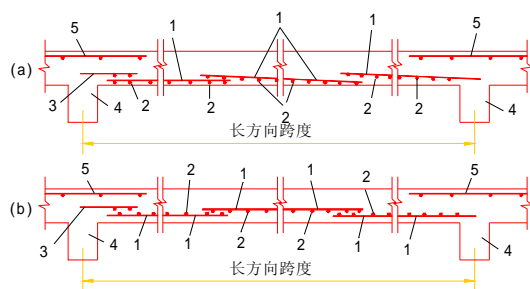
钢筋焊接网在双向板长跨方向的搭接
